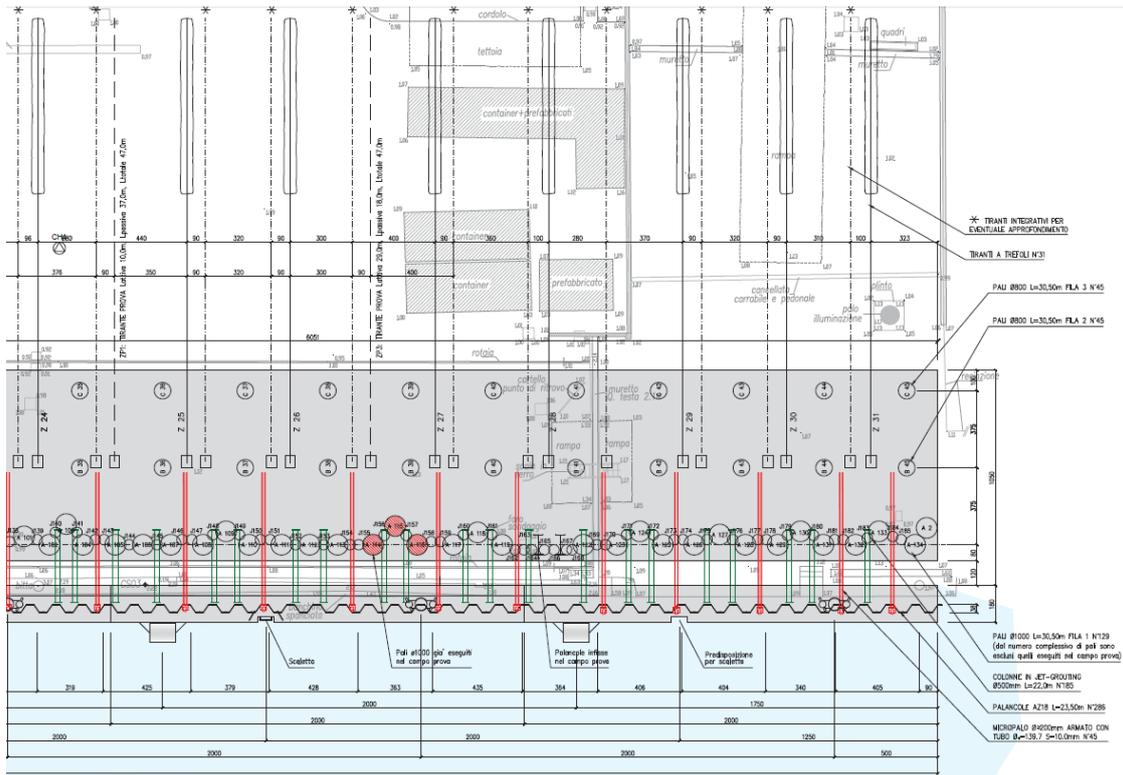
Bunge Nord – Progetto 2010 – Planimetria As Built
